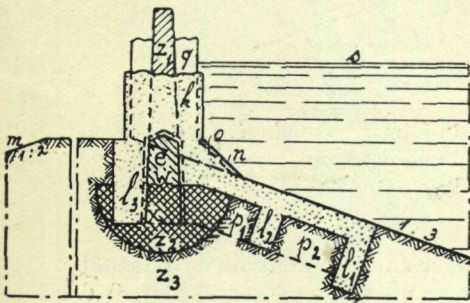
Croquis d'une coupe verticale d'un joint (voir fig. 26).
